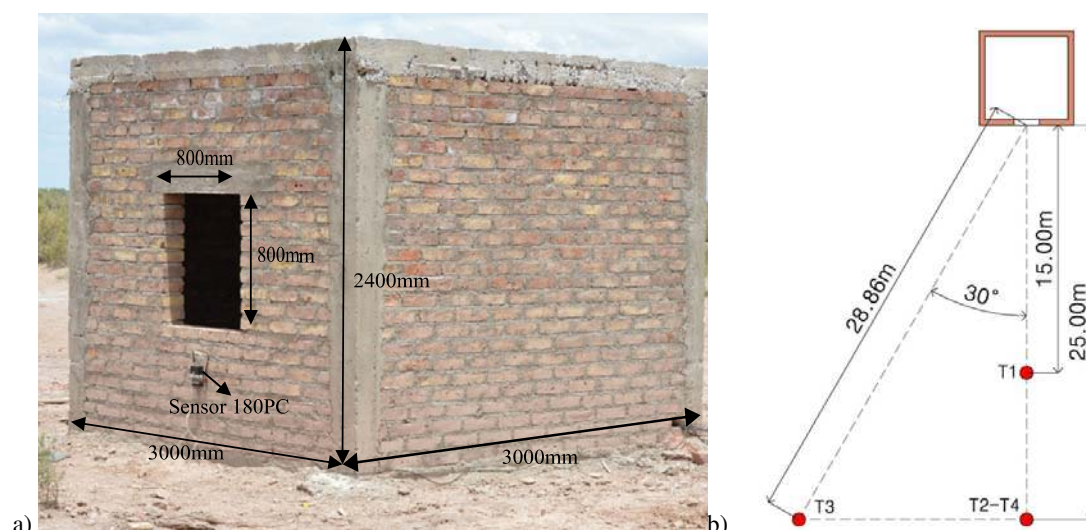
a) Estructura de mampostería con una abertura. b) Ubicación en planta de los explosivos
